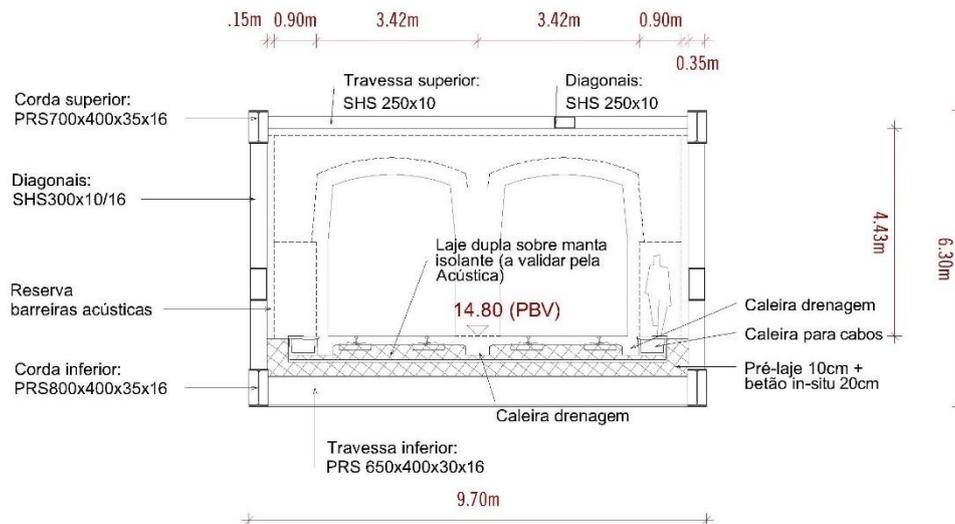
Corte construtivo Viaduto (ML 134364).
